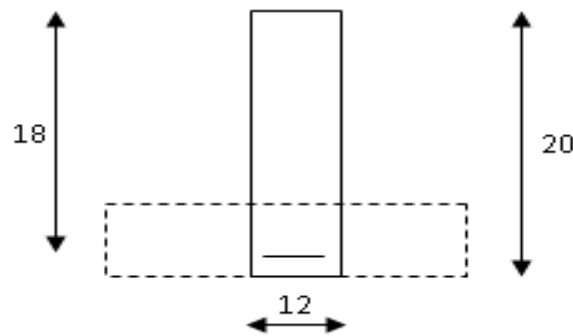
Section de calcul de la poutrelle aux appuis.
